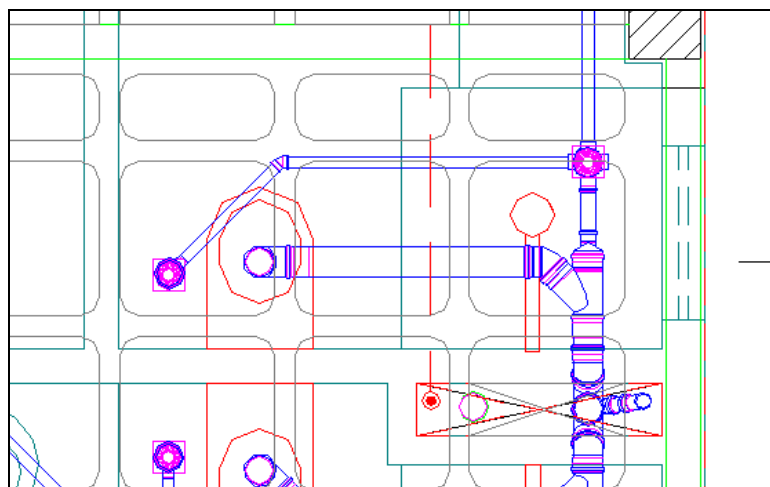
Caixa sifonada e Coluna de ventilação em conflito com as nervuras da laje
